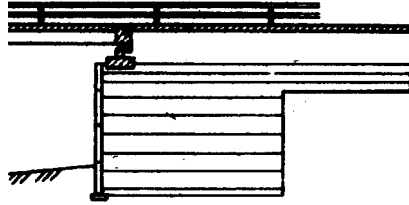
Береговой устой из армированного грунта со свайной опорой моста
